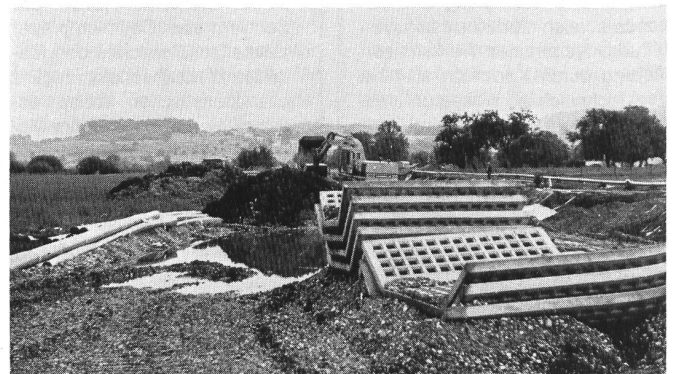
Bereitgestellte vorfabrizierte Kanalelemente aus Beton, die direkt auf das mit dem Bagger eingebrachte Beschwerungsmaterial verlegt werden.
